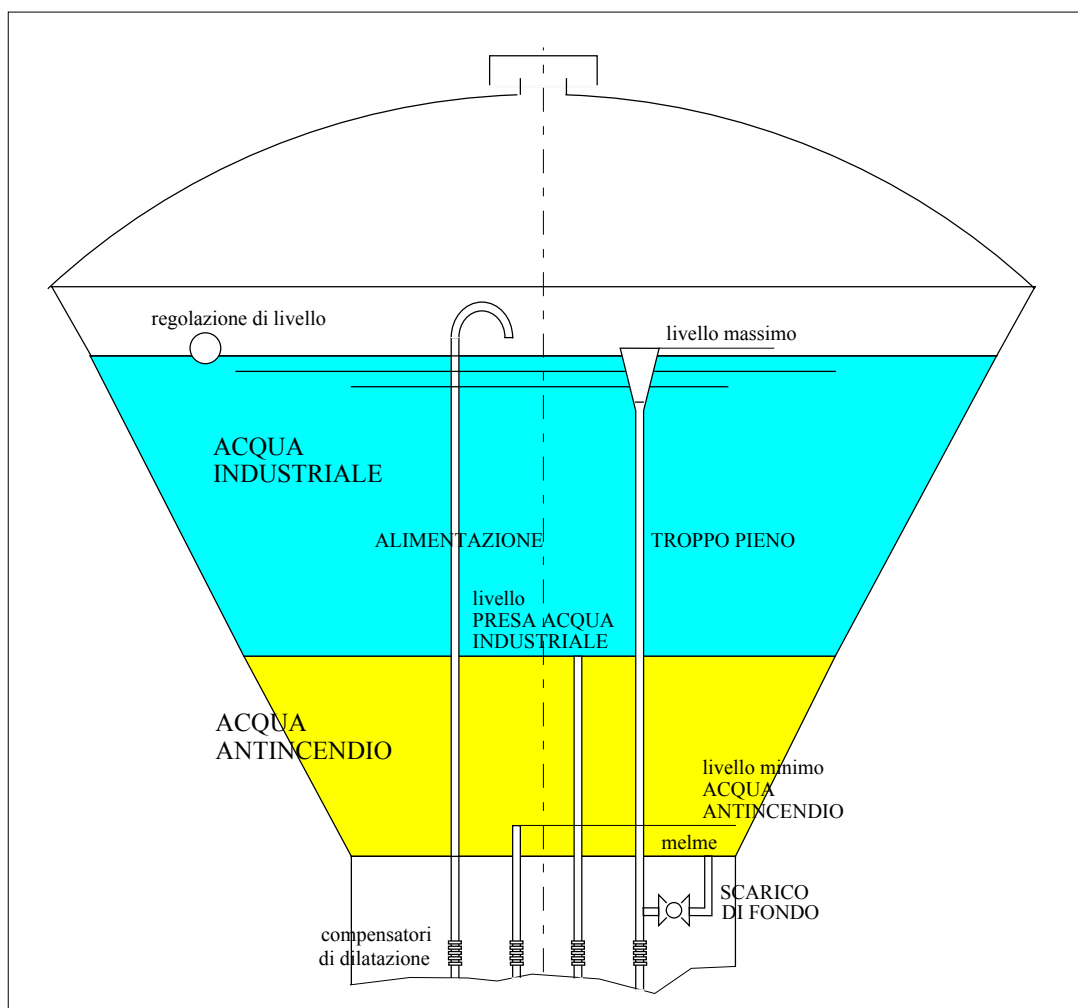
Schema del piping di un serbatoio sopraelevato.
